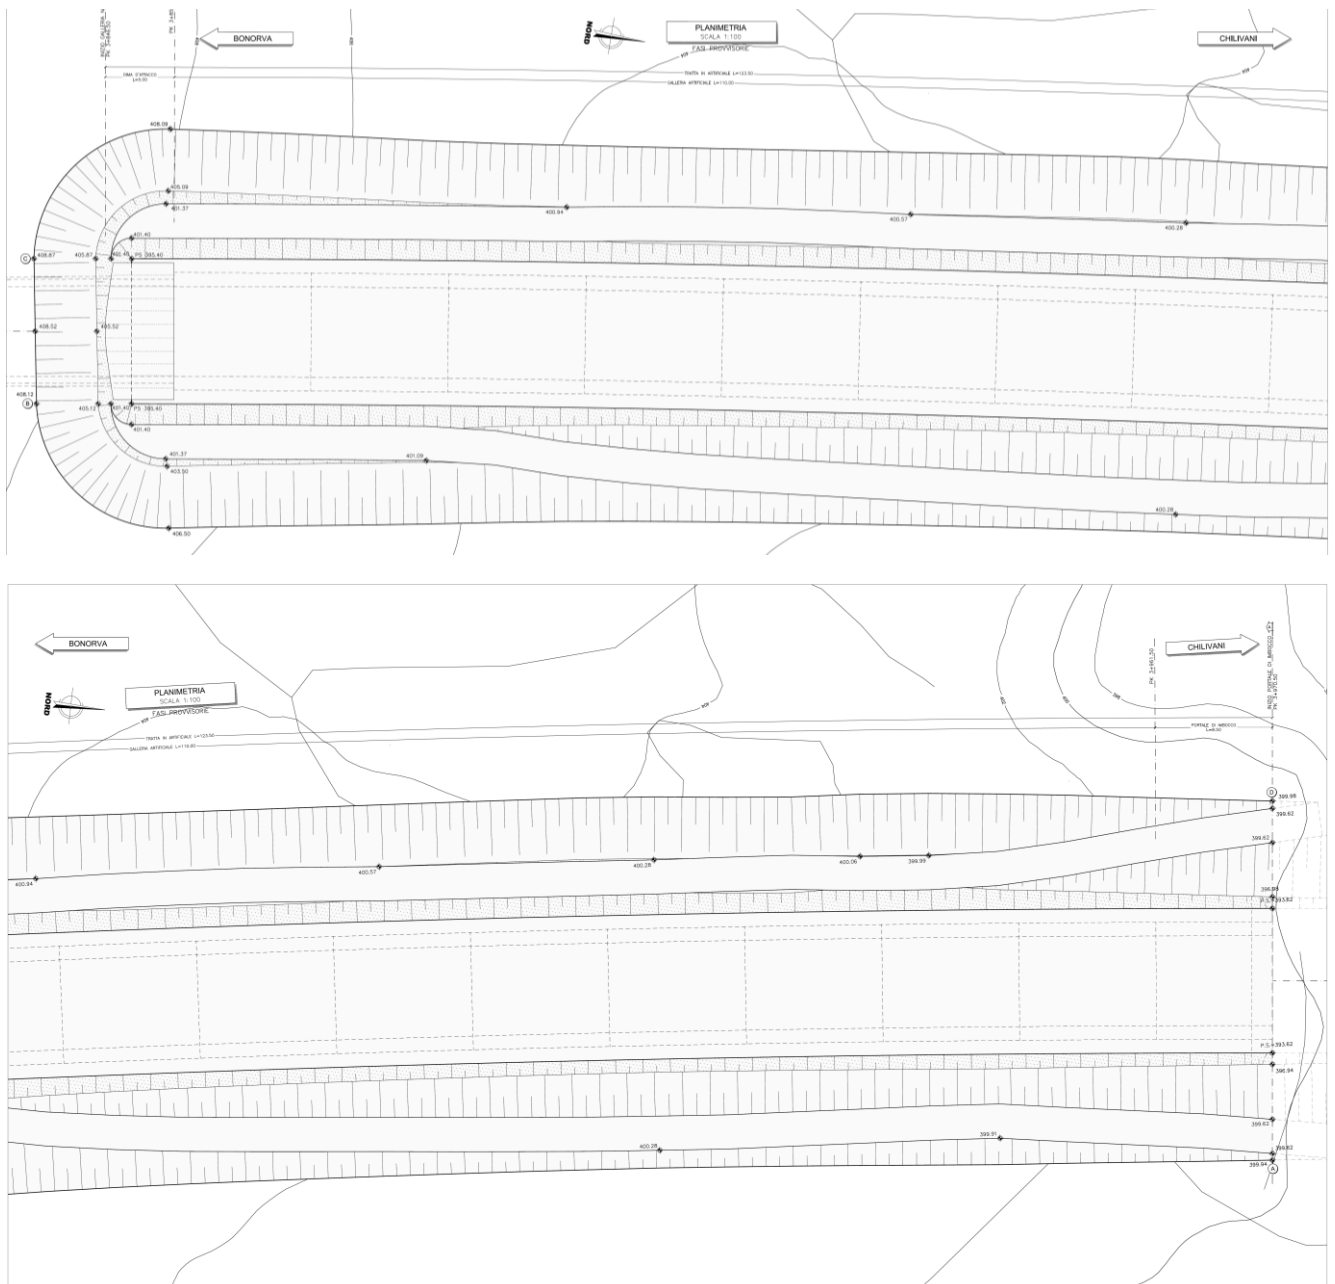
Galleria Giave – Imbocco lato Chilivani – Planimetria in fase provvisoria
